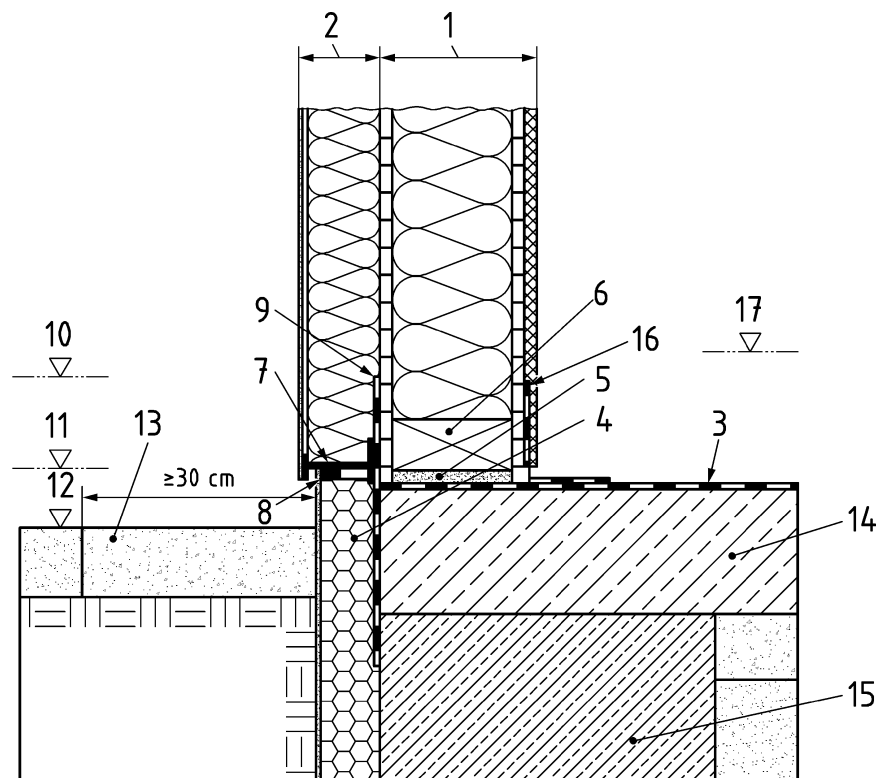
Außenwand-Fußpunkt mit Schwelle außerhalb Spritzwasserbereich mit Wärmedämmverbundsystem
